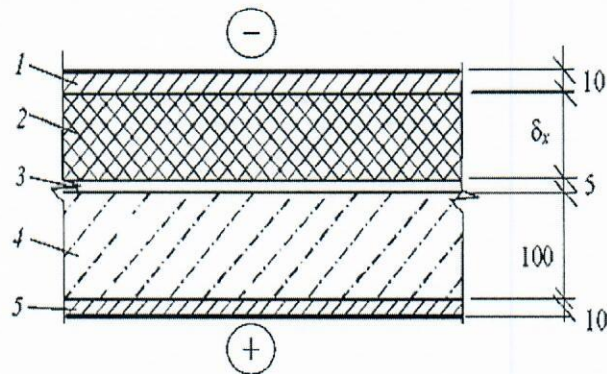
Вариант 2-й конструкции чердачного перекрытия:
